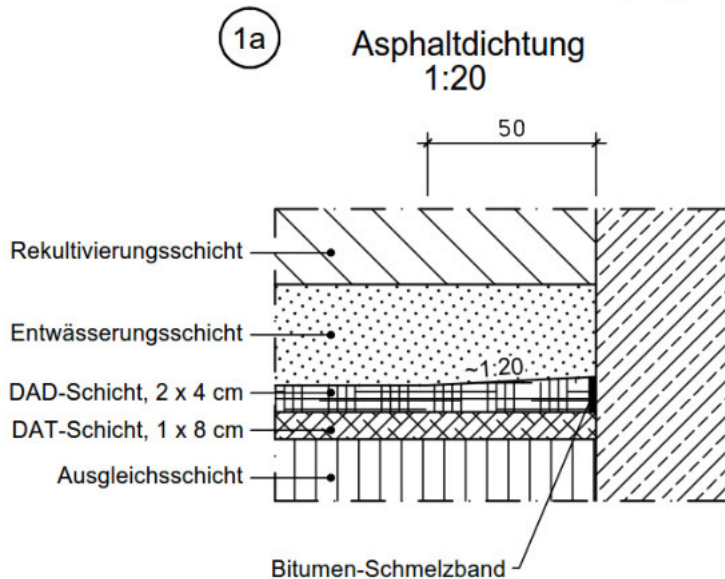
Asphalt an Betonbauwerke, Auszug aus Anlage 08.03.01
